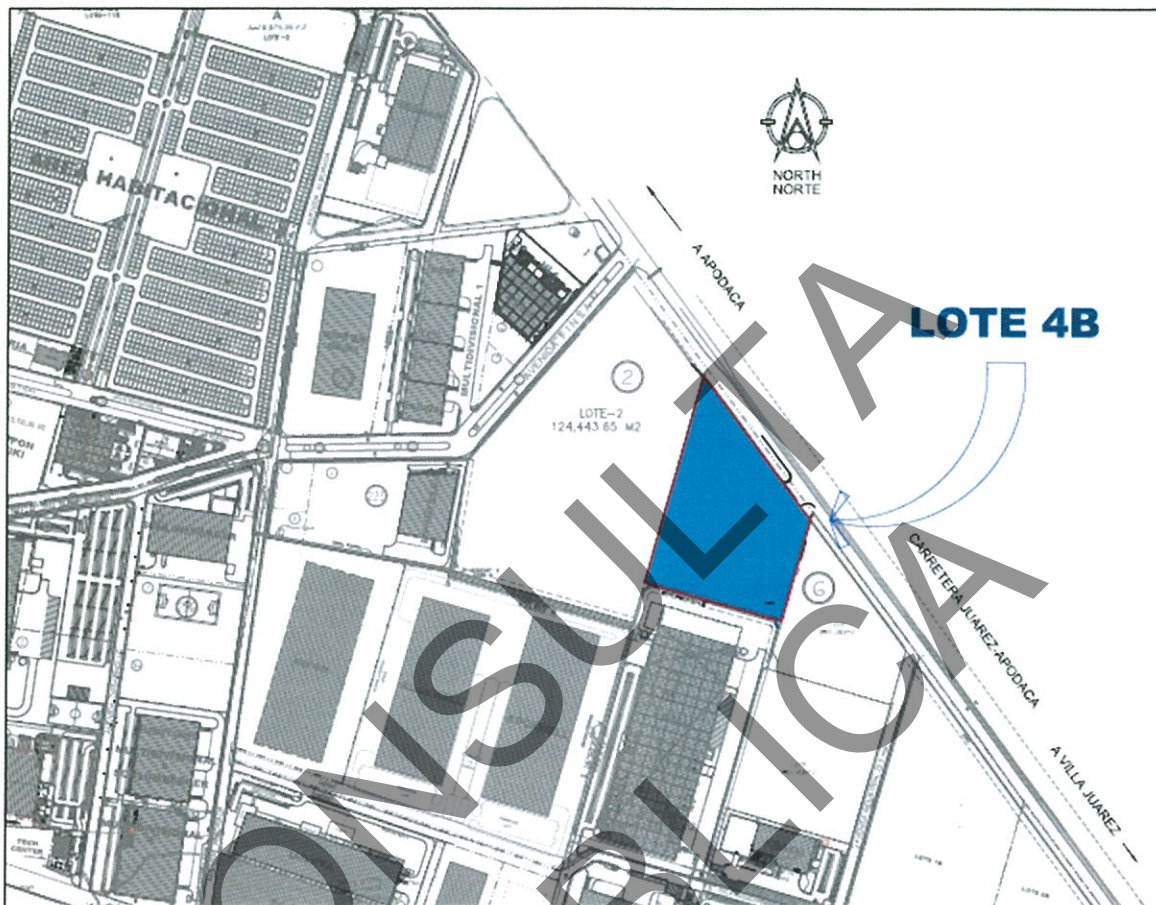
Vista en Planta del proyecto maestro proporcionado por el cliente.
